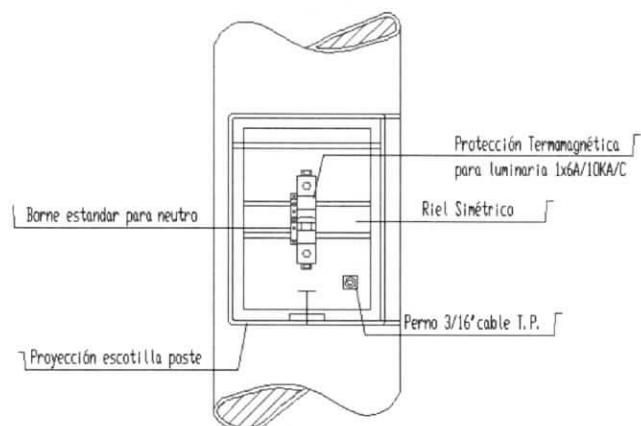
Detalle Protección de Luminaria en Poste Metálico.
